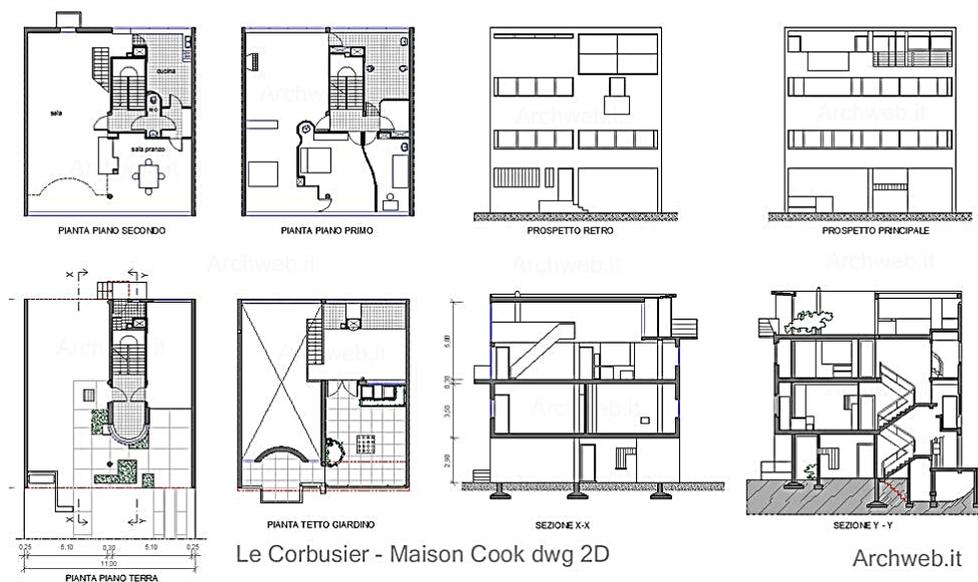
Вилла У. Кука. Планы этажей, схемы фасадов и разрезы<sup>14</sup>
